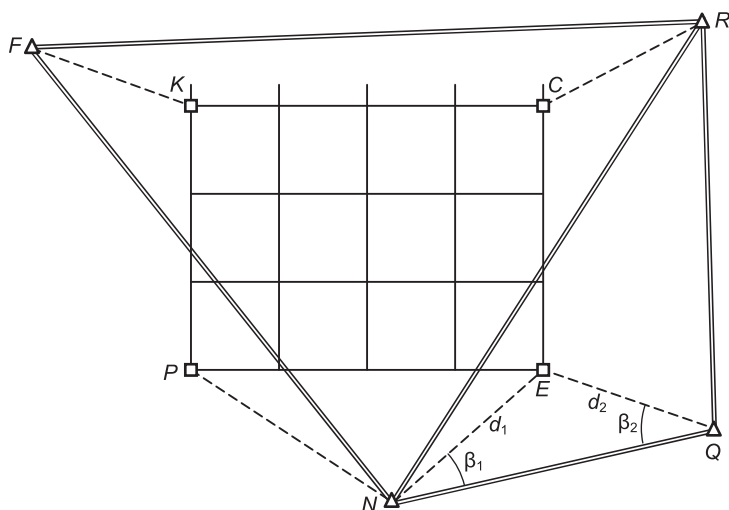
Одна из схем выноса в натуру проекта строительной сетки
